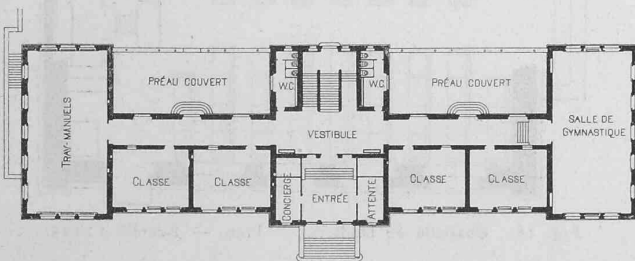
Plan du rez-de-chaussée. — Echelle 1 : 800.
